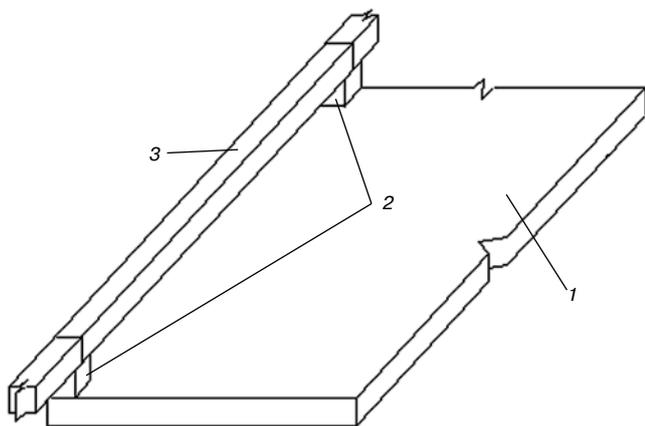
Фрагмент решения углового соединения цокольного перекрытия и стены монолитного здания после укладки балки: 1 – монолитное цокольное перекрытие; 2 – опоры из железобетона или легких конструктивных бетонов; 3 – железобетонная балка
